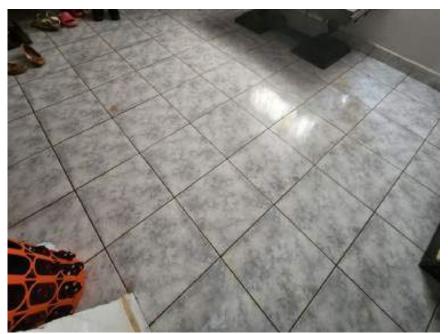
Detalhe, Piso cerâmico (pavimento superior).
